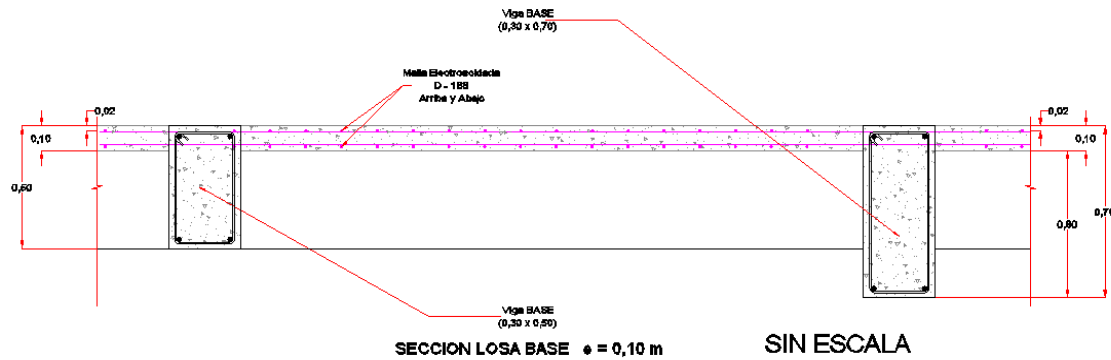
Cimentación propuesta para proyecto/Fuente estudio de suelos Constructora Mys
